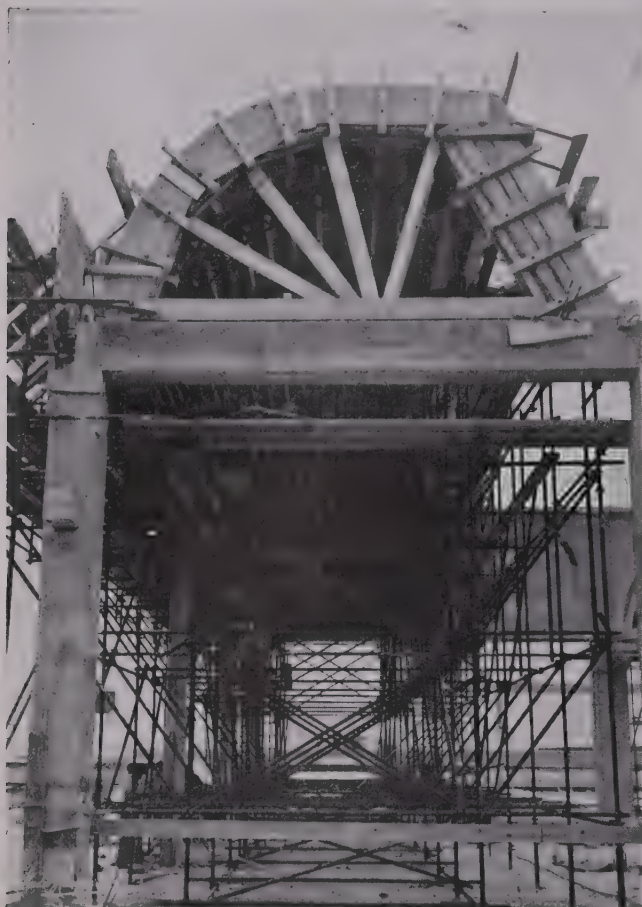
Échafaudage d'un shed et coffrage du tympan sur poteaux. (Photo Hacquart, Amiens.)
